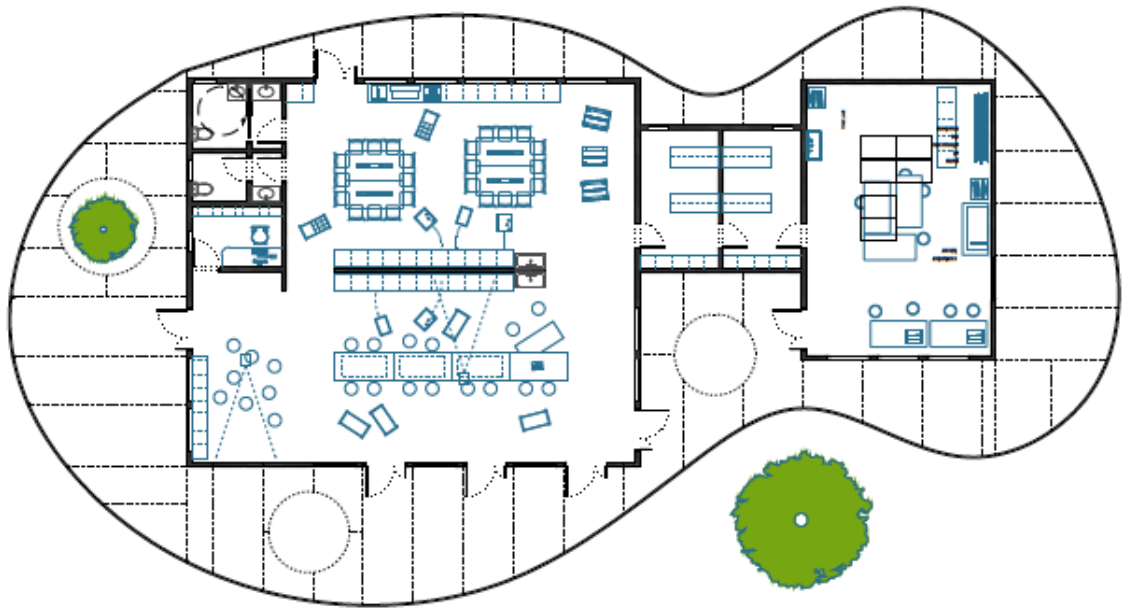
Plano, vista en planta del Atelier de la Unidad Educativa-UNAE.
